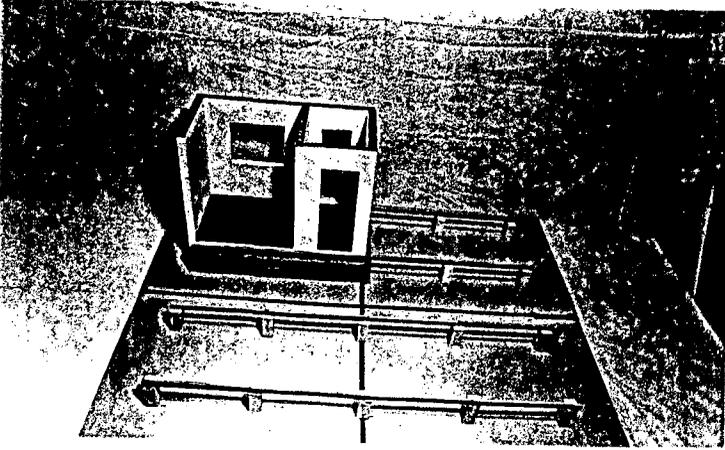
Colocação das vigotas do piso, apoiadas nos pilaretes e niveladas.
